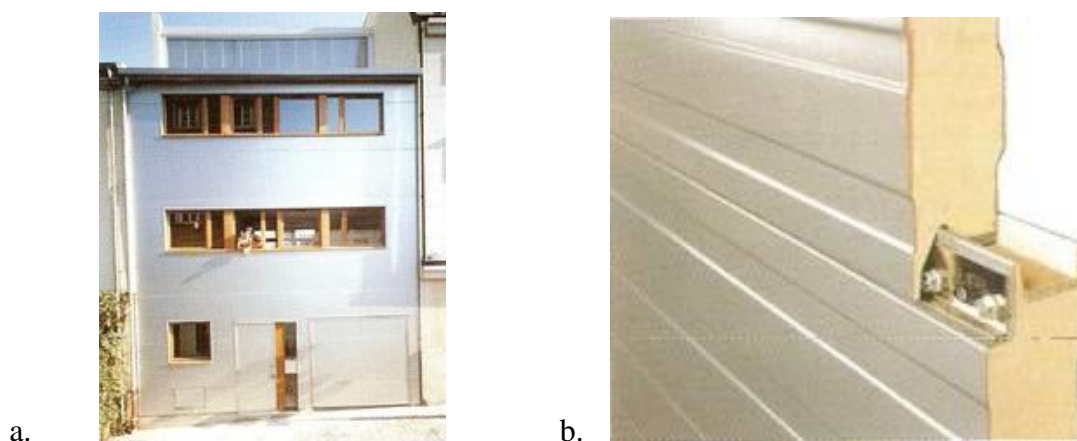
a. Panneaux sandwich en façade, fixés sur une ossature secondaire en bois. Maison à Paris Ige, Georges Maurios architecte. b. Panneau-sandwich à fixations cachées.
